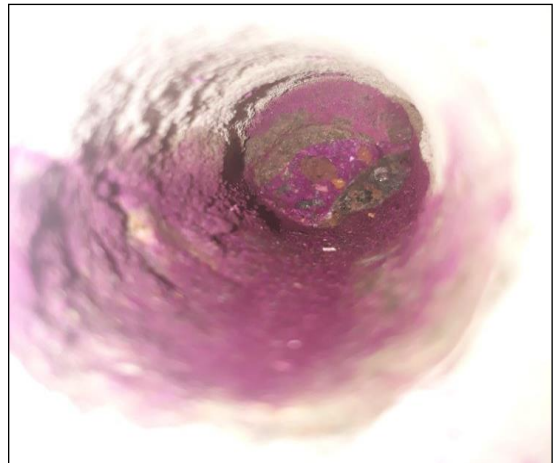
Prueba de fenolftaleína muro C sección 1
